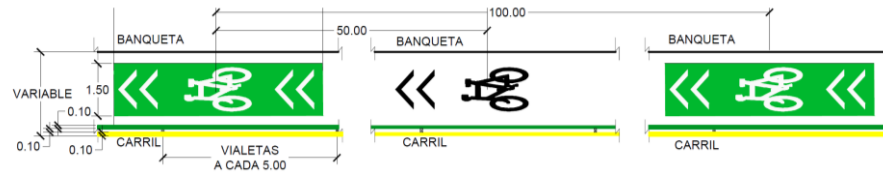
Detalle de señalamiento horizontal Tipo 1, manzanas mayores a 100m.
